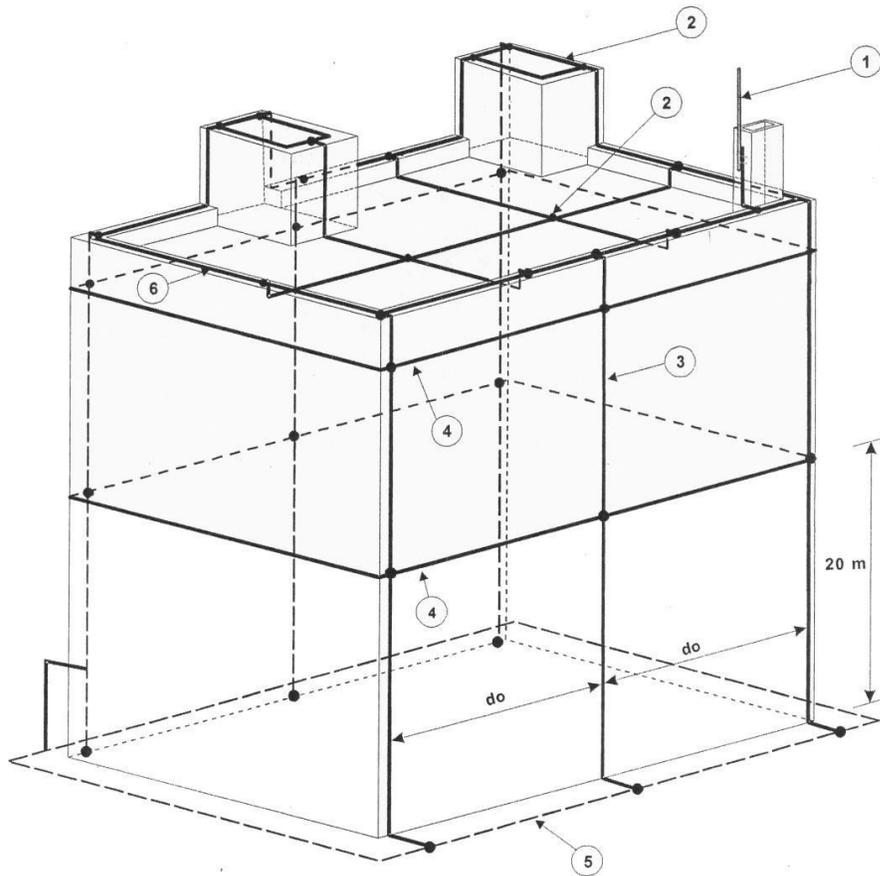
Diagrama entre los elementos del SEPTE con el SPT, para lograr la UE en edificios o estructuras de 60m o menor, construida de concreto armado o perfiles metálicos.
